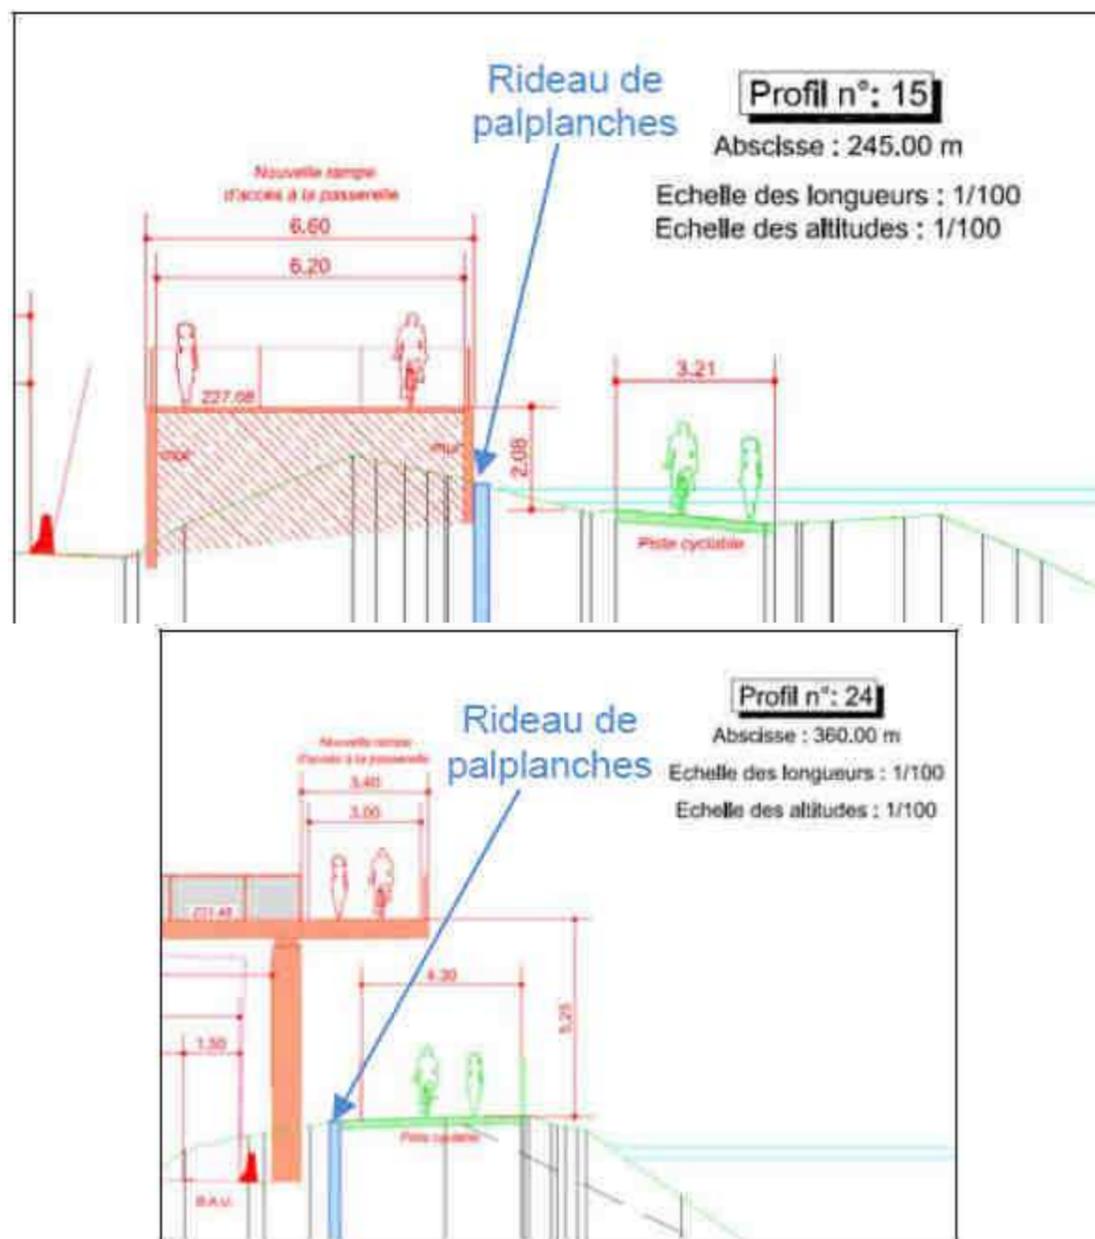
Localisation des palplanches sur les profils 15 et 24
